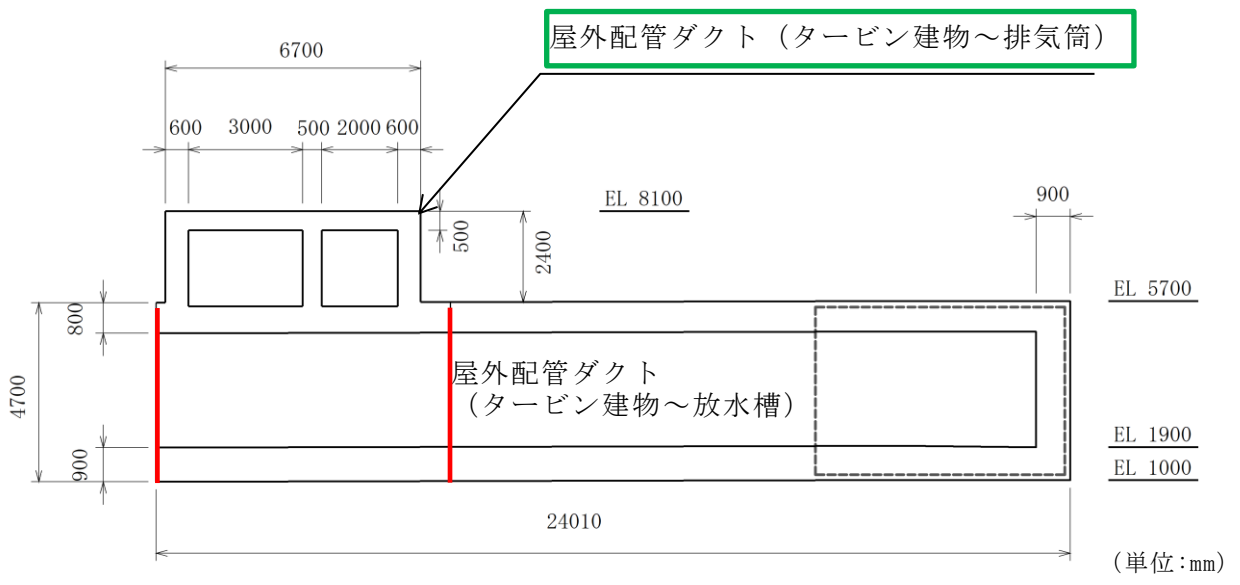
屋外配管ダクト (タービン建物～排気筒) 断面図 (B-B 断面)
